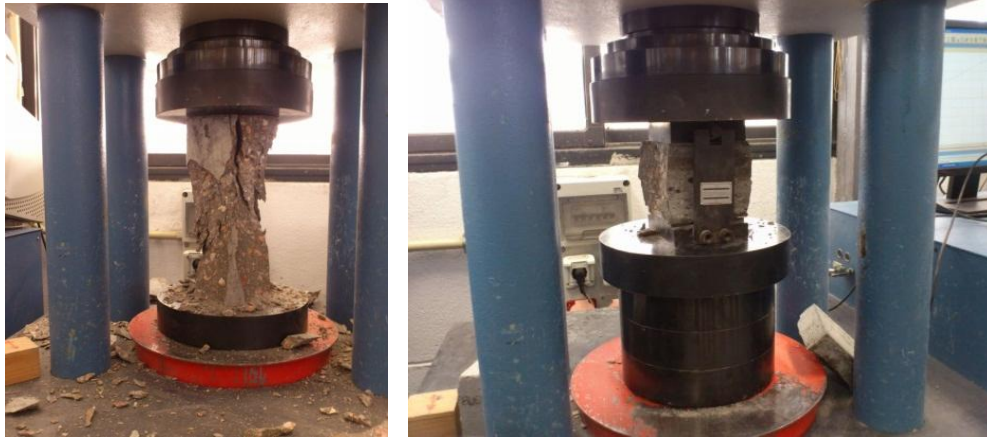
14 Ensayo Compresión probeta cilíndrica (izquierda) probeta prismática (derecha)
